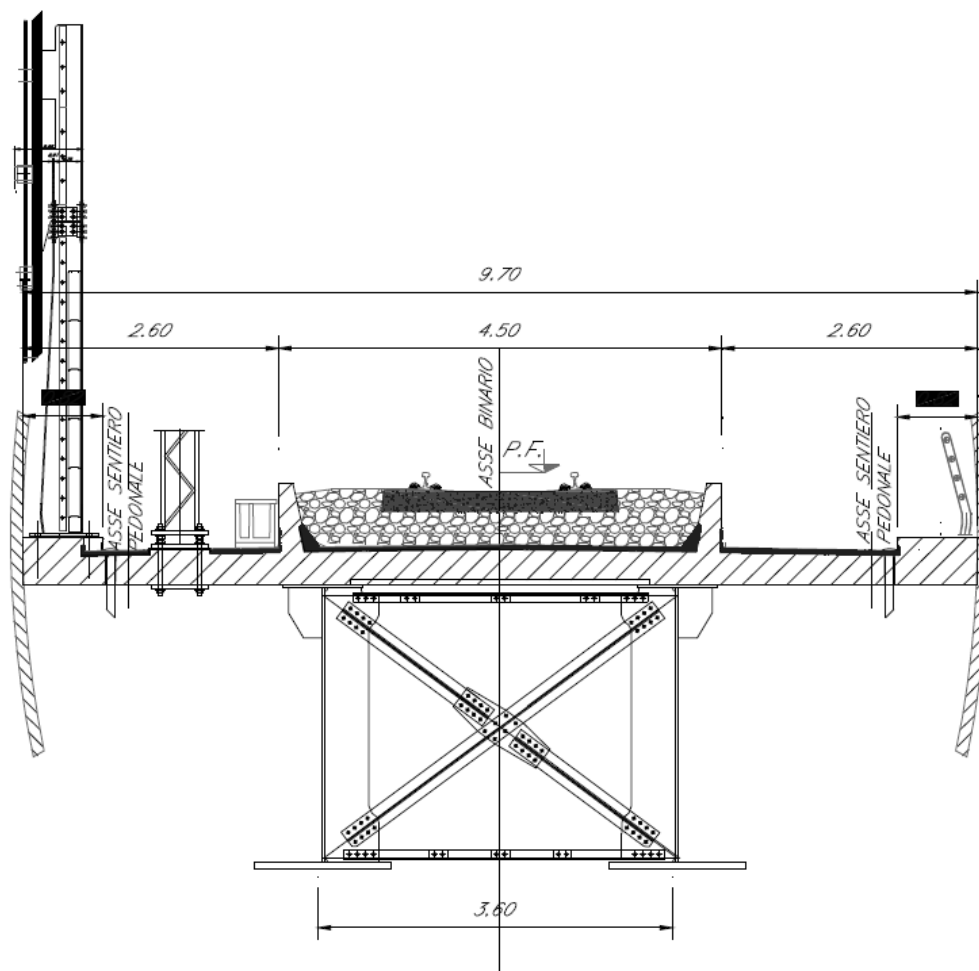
Sezione tipo dell'impalcato a struttura mista acciaio calcestruzzo a singolo binario
